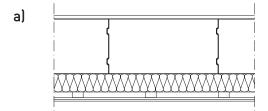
Двухслойные наружные стены из блоков YTONG с дополнительным утеплением системой
